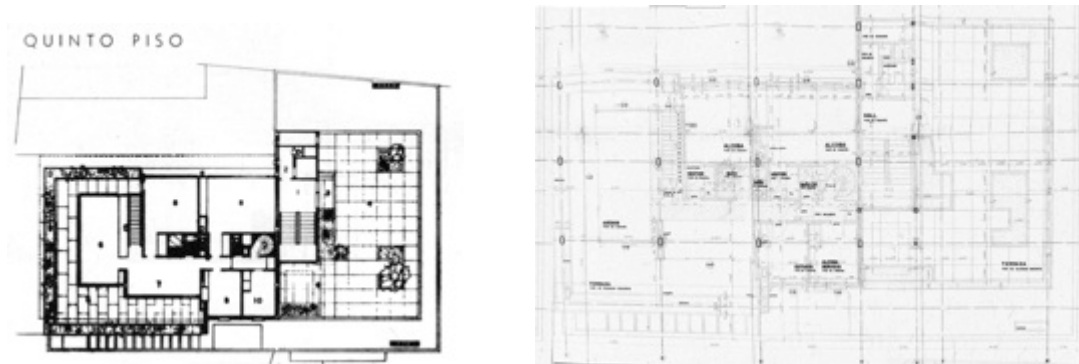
Quinto Piso – Segundo Nivel del *Pent House
